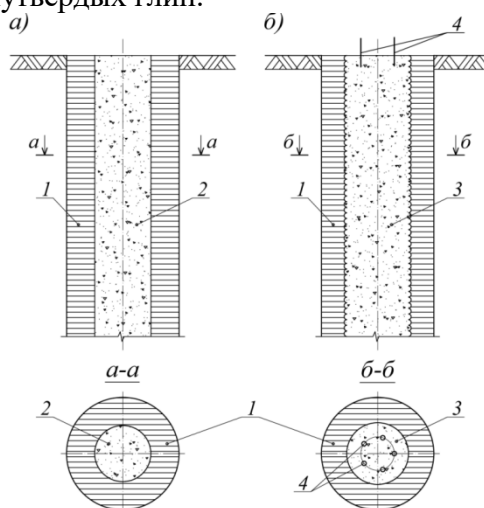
Схема устройства грунтобетонной сваи (ГБС).
